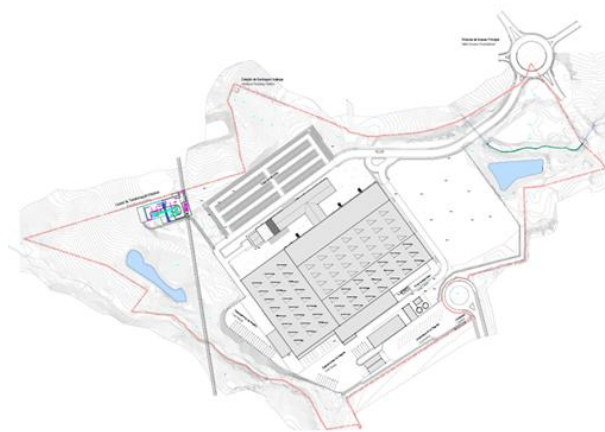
Planta de implantação do projeto (Fonte: EIA – Elementos pós visita, janeiro 2026)
